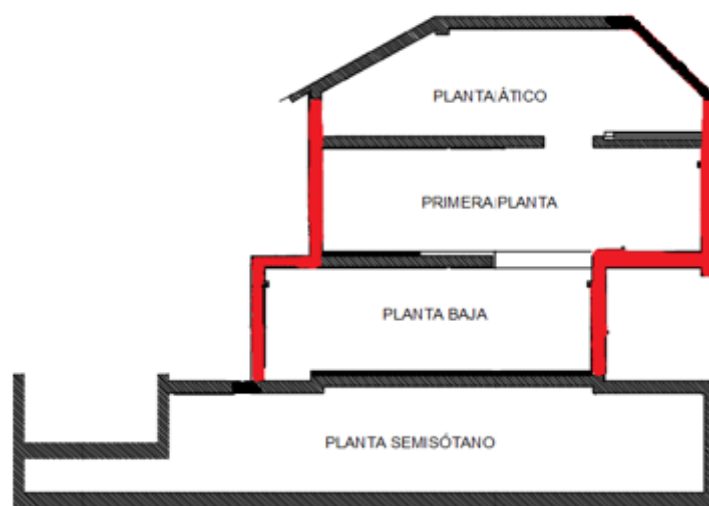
Cerramiento de la fachada en la sección transversal de la vivienda
